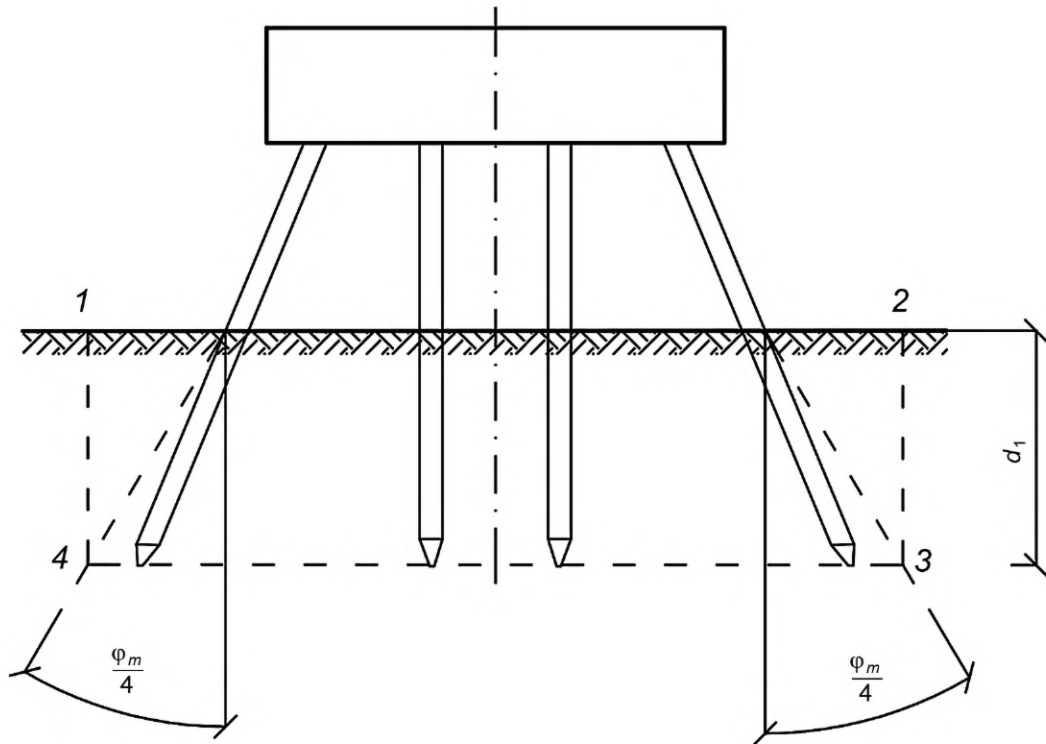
Условный свайный фундамент с ростверком, расположенным над грунтом, при угле наклона свай менее $\varphi_m/4$
